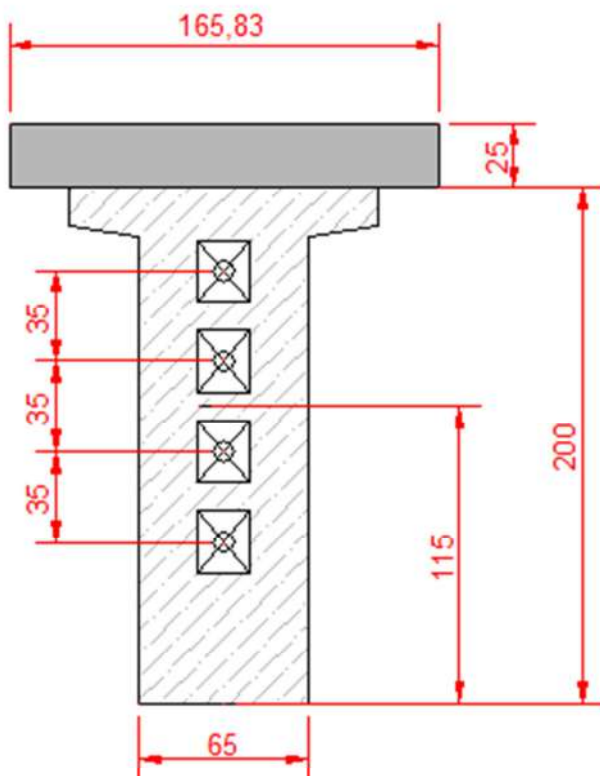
emplacement des plaques d'ancrage dans la section about
